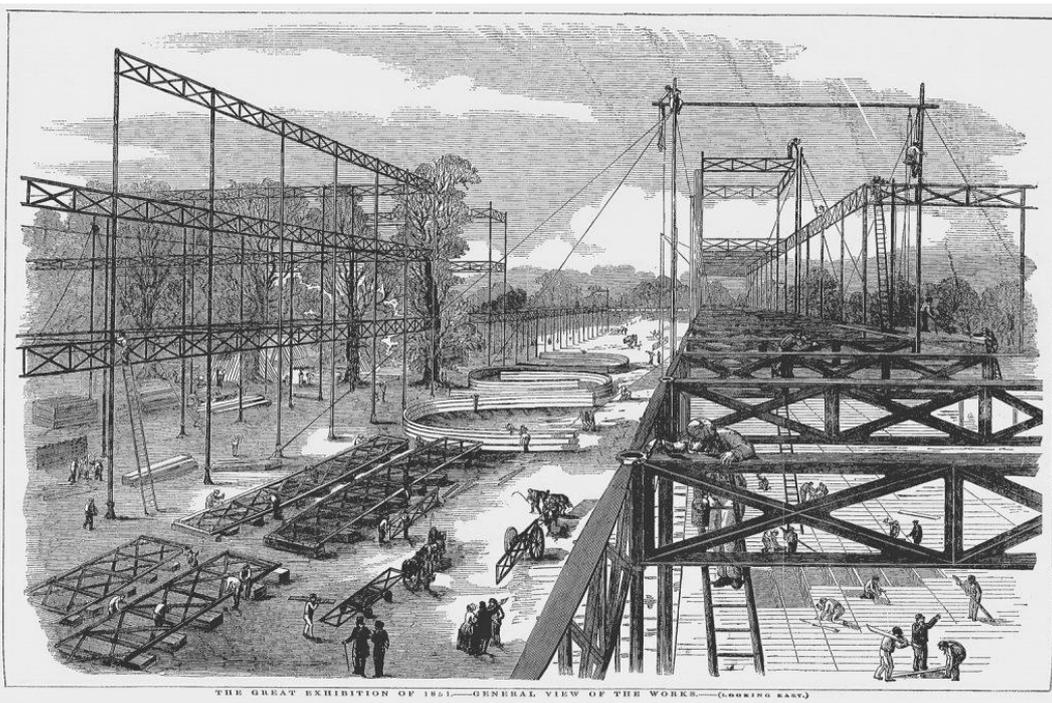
Vista general de la construcción del Crystal Palace de Paxton para The Great Exhibition de 1851. Estructura prefabricada de acero. (London Illustrated News, 1850)
